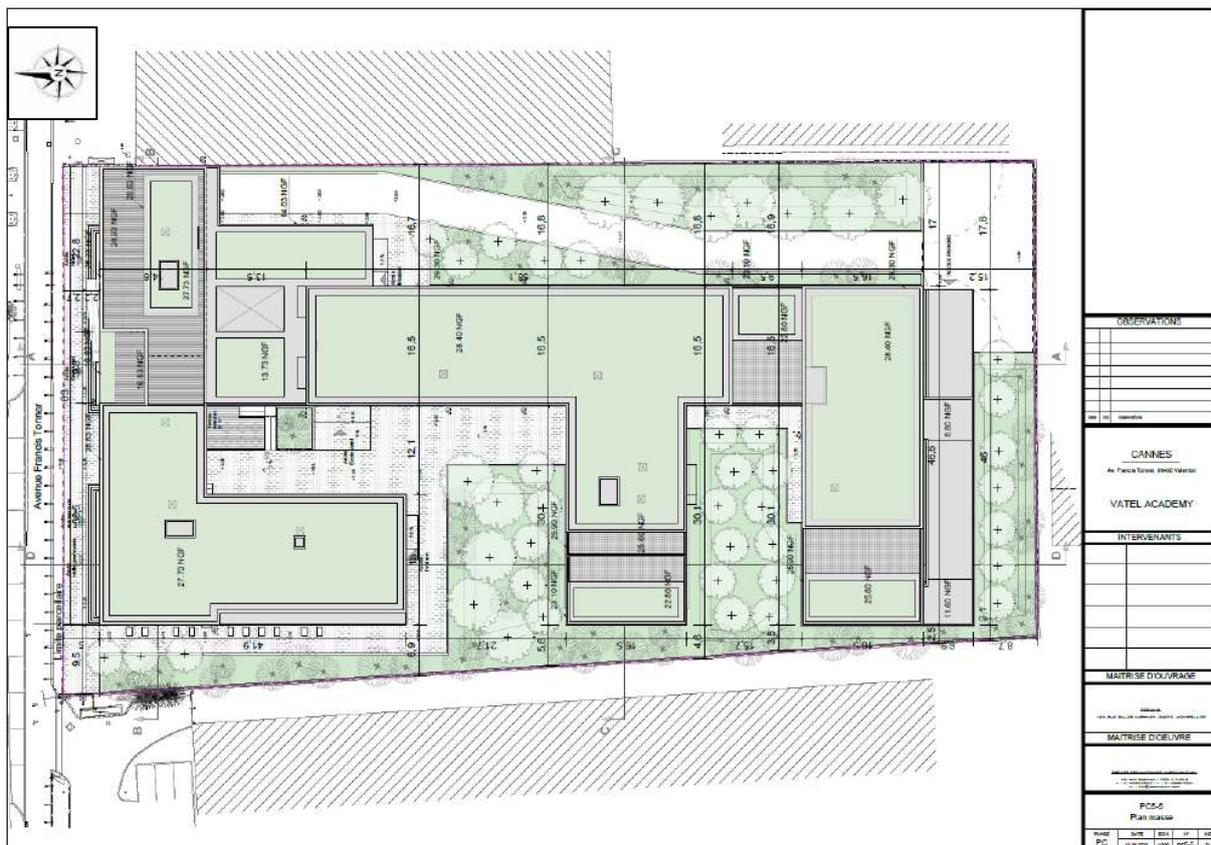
Plan masse du projet – sans échelle (Source : Architecte EAI - 18/09/2023)
